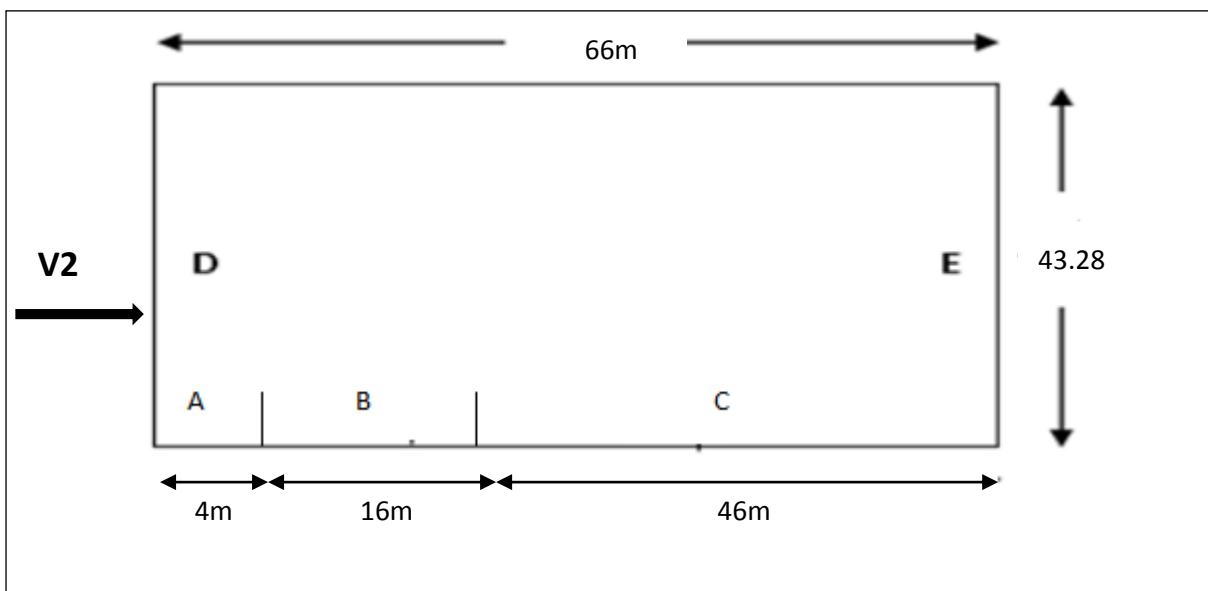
Vue en plan des zones de pression sur les parois verticales sens V2.
